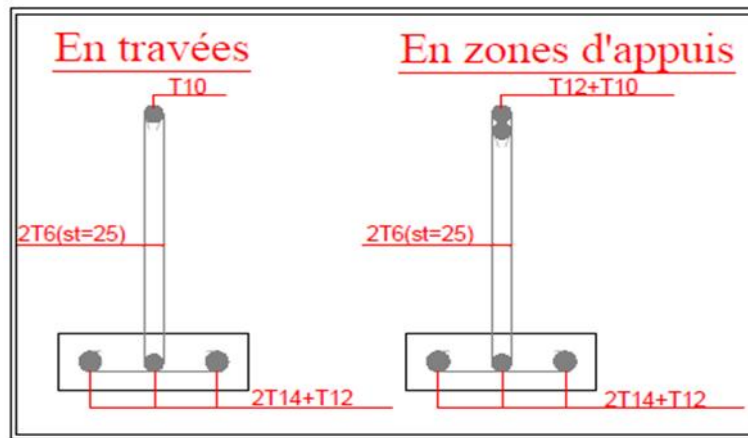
ferrailage des poutrelles en travées et en appuis.
